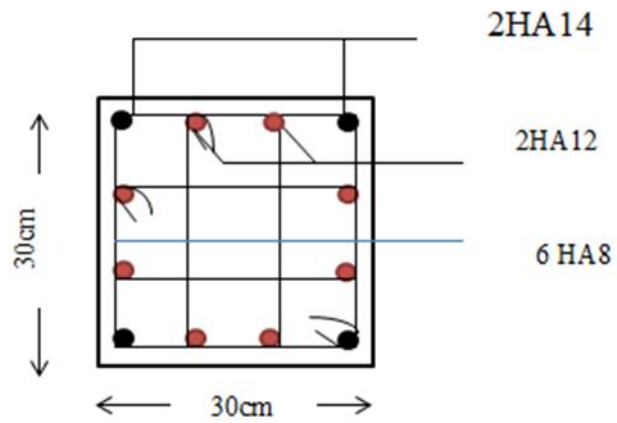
Schéma de ferrailage des poteaux du 7^{ème} et étage Technique.
